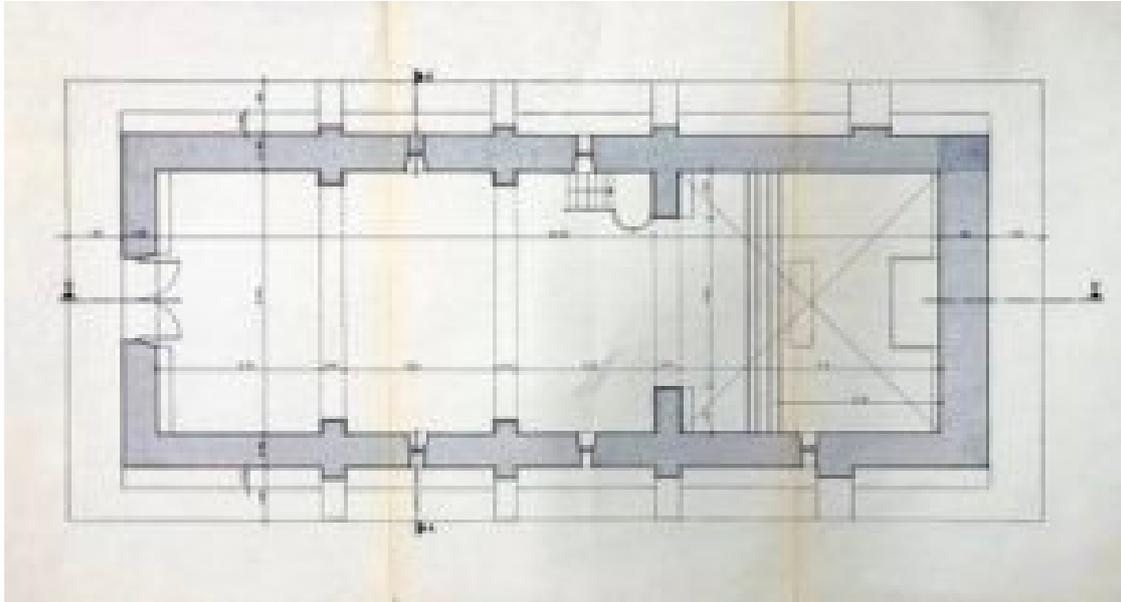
Plano 8. Planta distribución (reformada)[51]
